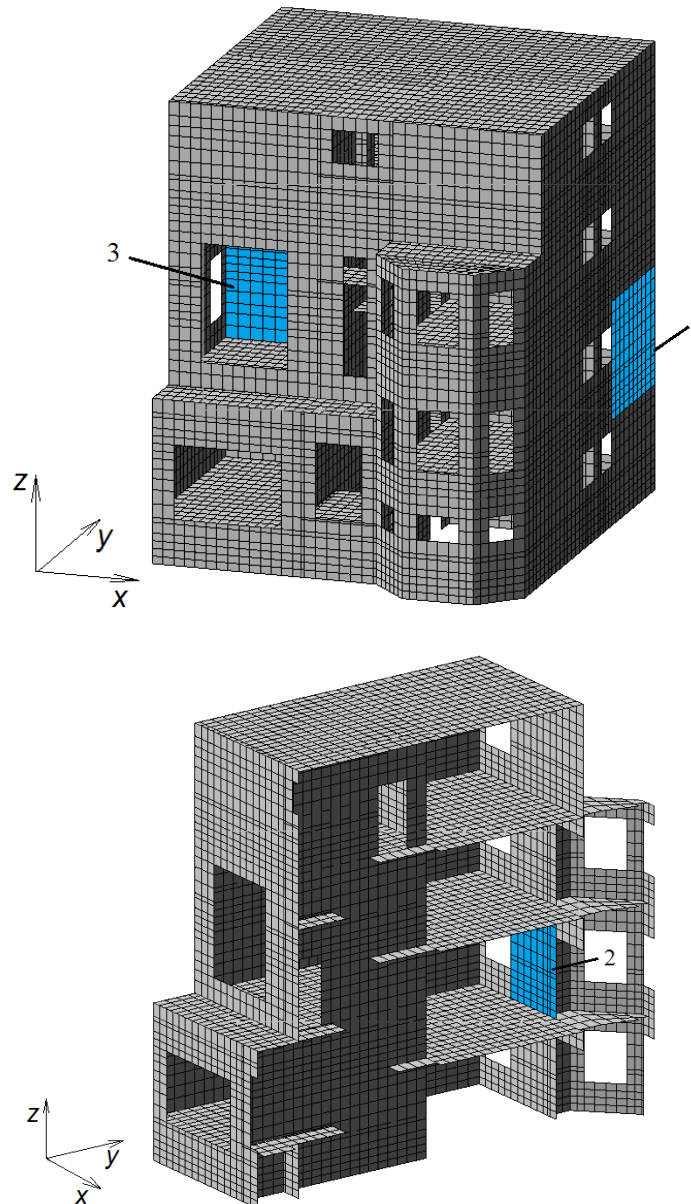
Пространственная модель 3-х этажного жилого дома с несущими стенами из газобетона
